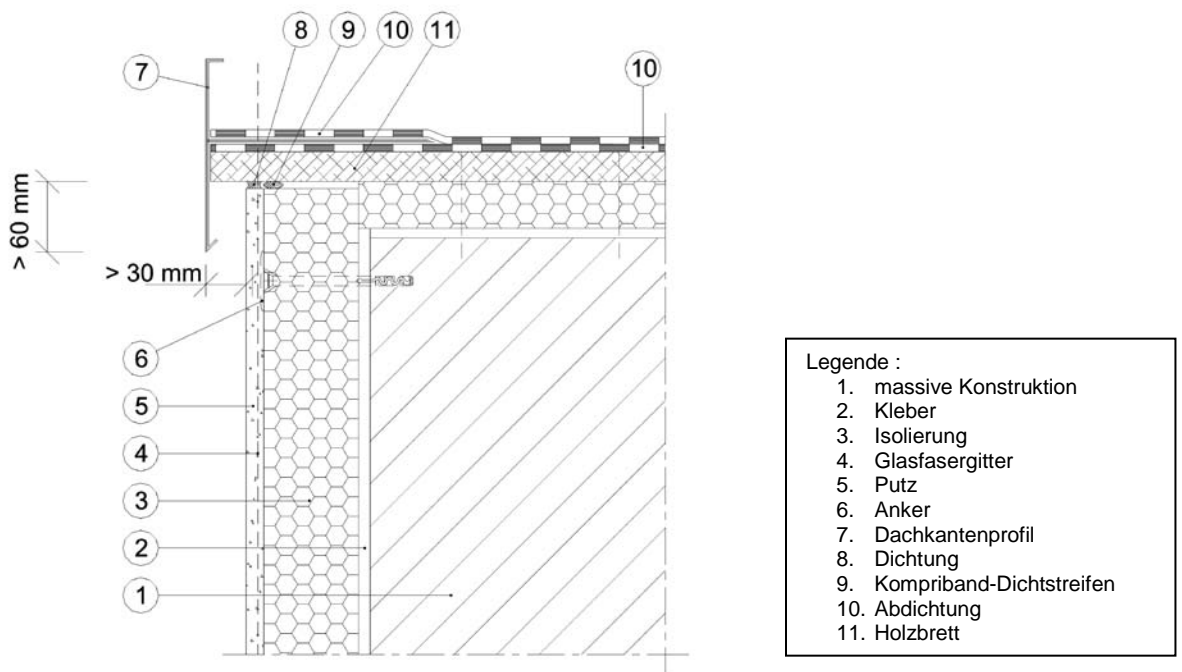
Bauliche Durchbildung einer Flachdacheinfassung mit Dachkantenprofil
